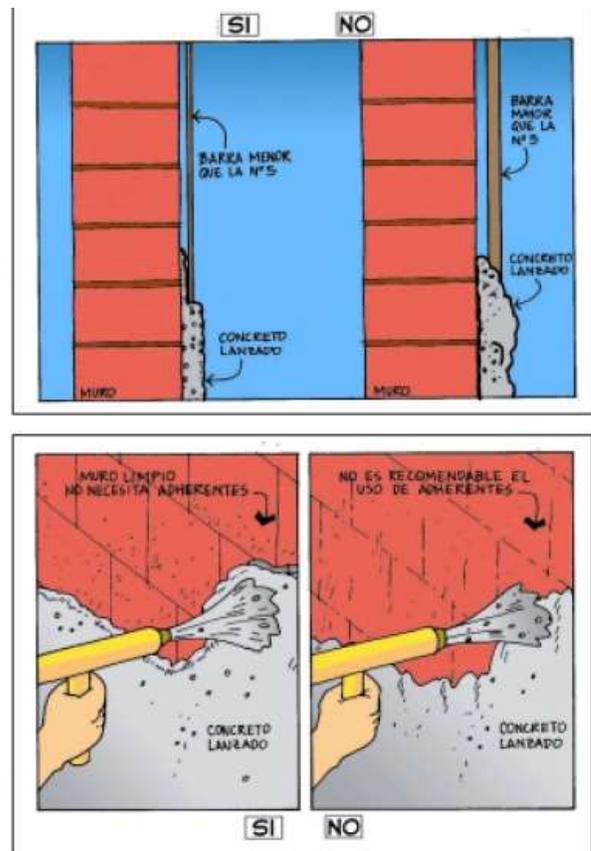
Recomendaciones para el reforzamiento con concreto reforzado (Control de Calidad y Limitaciones). Fuente Manual AIS de reforzamiento de viviendas en mampostería
